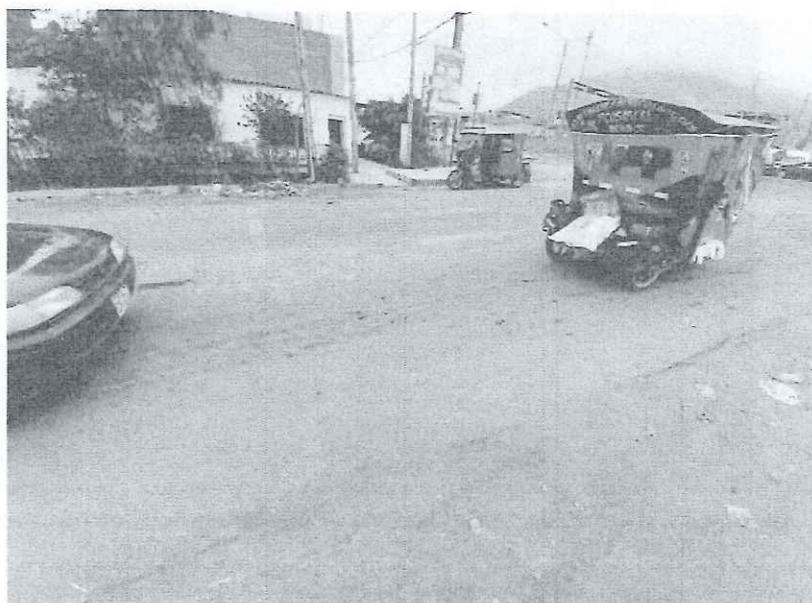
SE APRECIA GRIETAS Y FISURAS ENTRE AV. EGIPTO – AV. JOSE GABRIEL CONDORCANQUI
